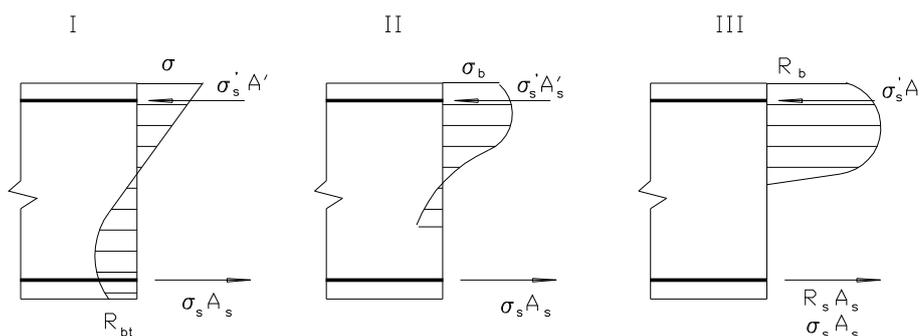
Три стадии напряженно-деформированного состояния изгибаемого железобетонного элемента
